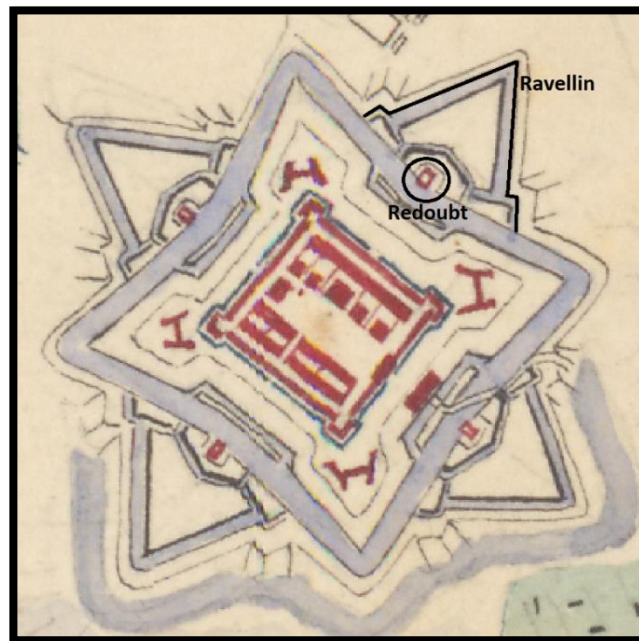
Denah bastion eksternal dan internal Benteng Willem I Ambarawa
